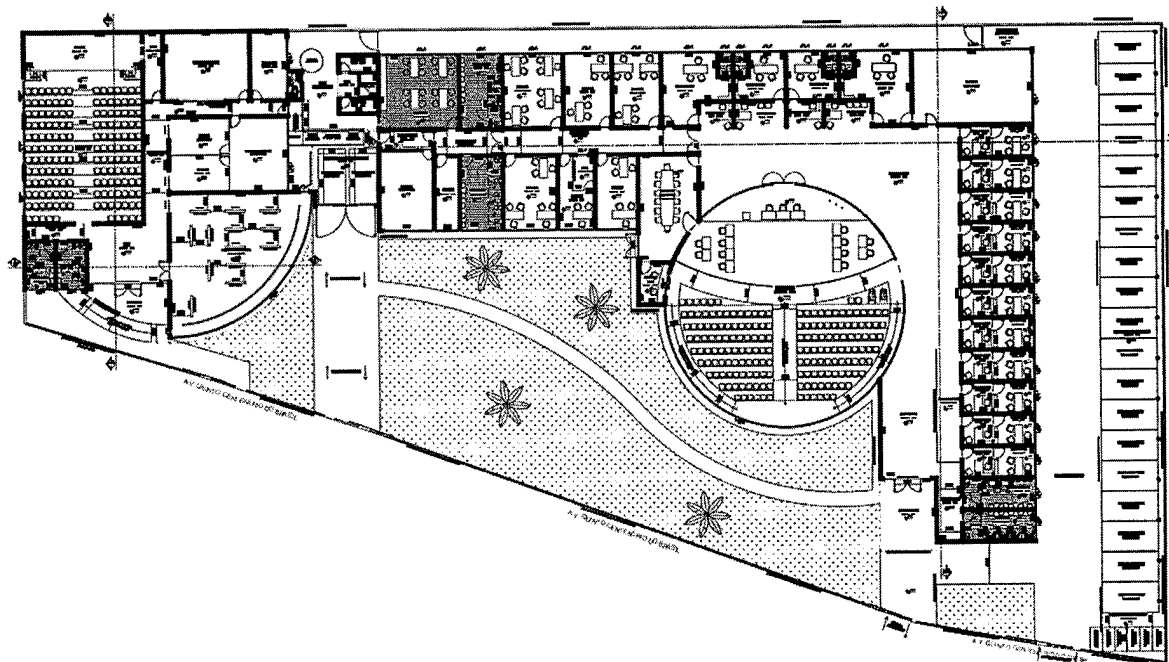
Pintura geral parede fachadas, face interna muros de divisa e gradil metálico
